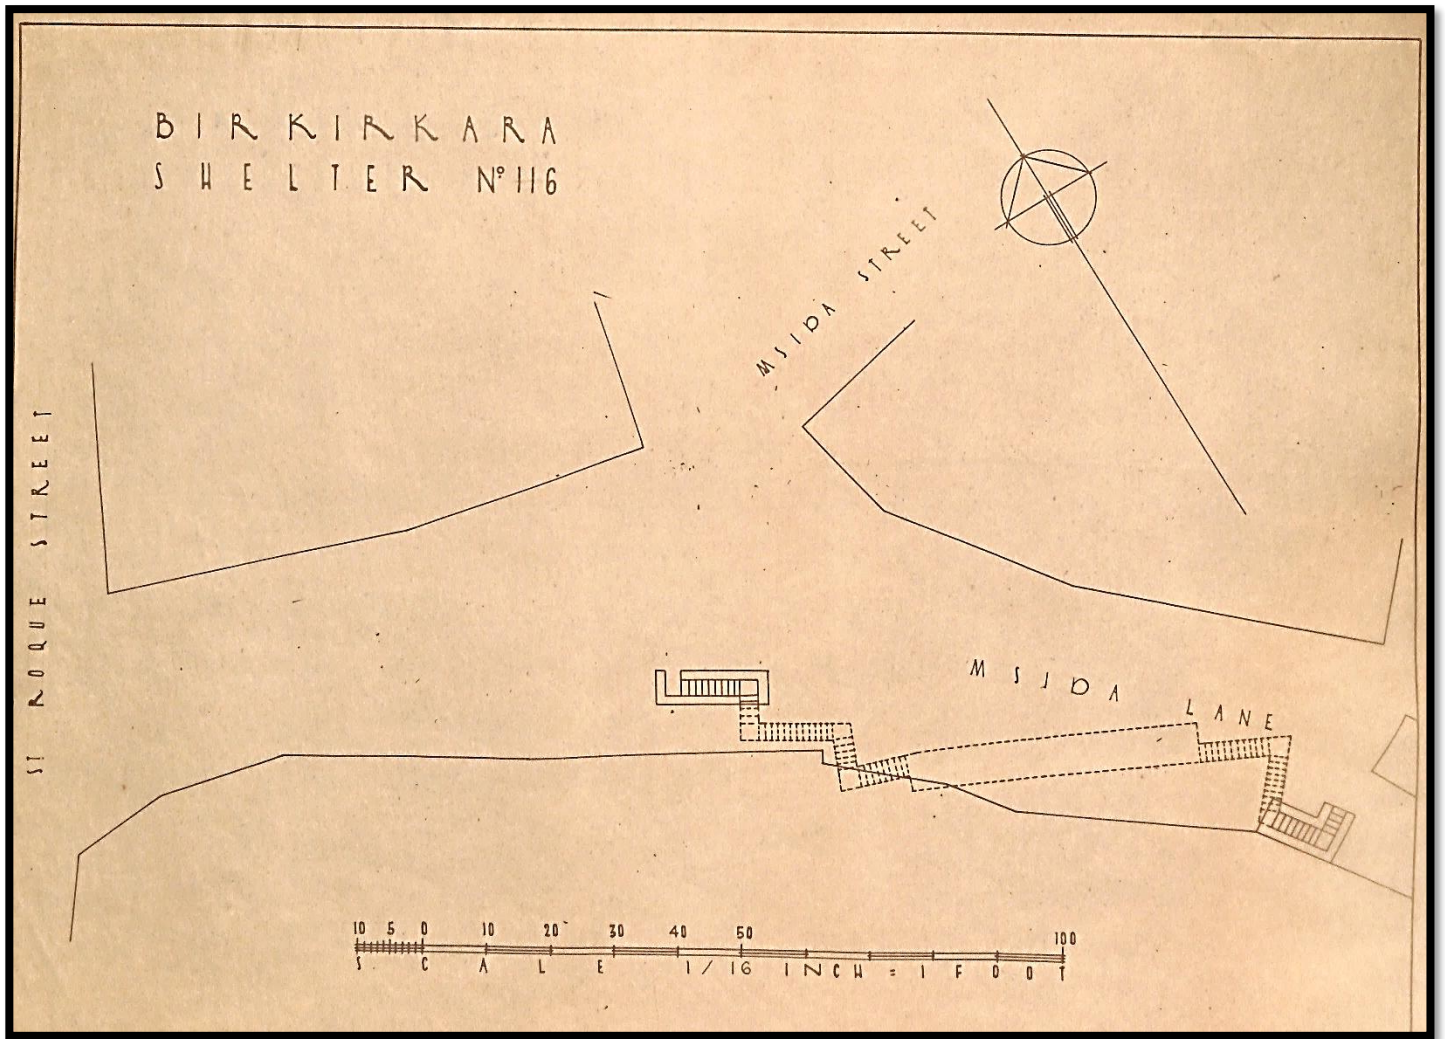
Planta do Abrigo nº 116 "St. Roque Street – Msida Street – Msida Lane"
